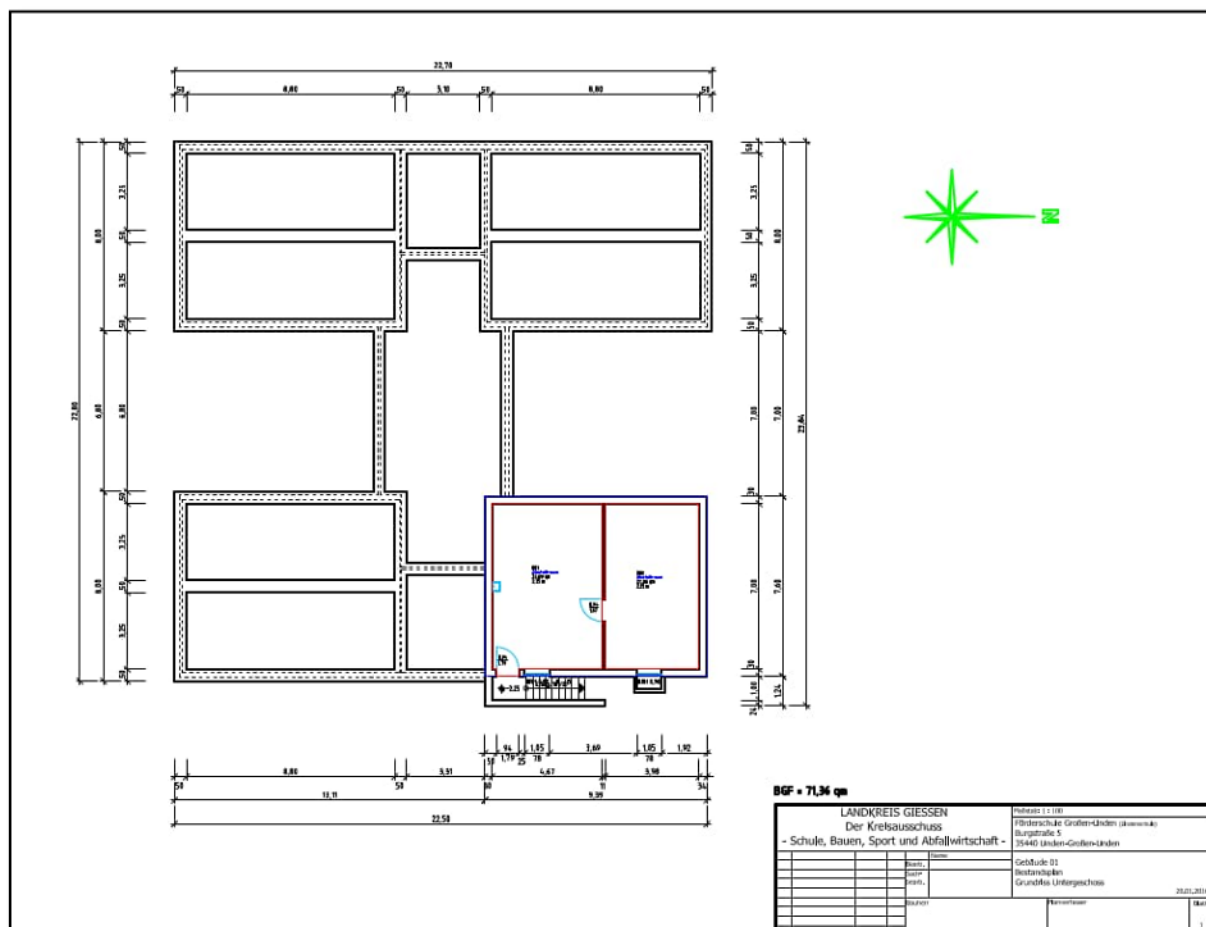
Grundriss des teilweise rückgebauten Schulgebäudes
